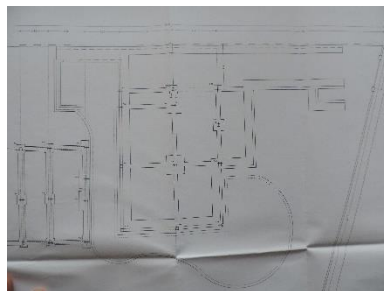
Extracto del plano de cimentación. Fuente propia. 2018
